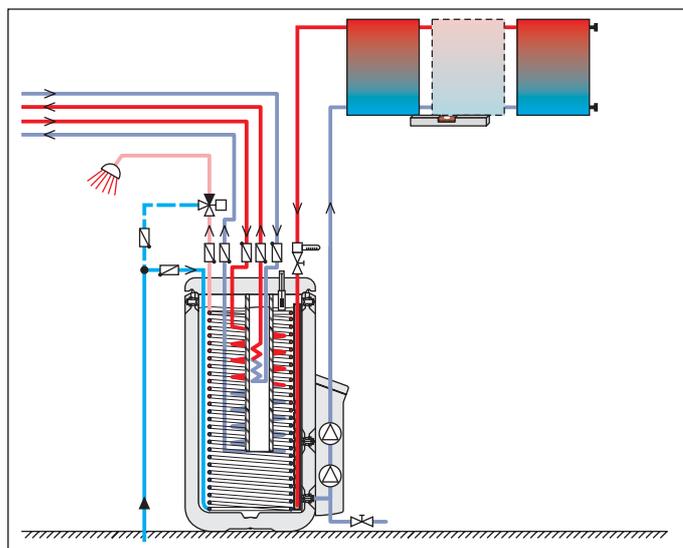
Campo solare dei collettori con collegamento sullo stesso lato e accumulatore di acqua calda EKHWP
